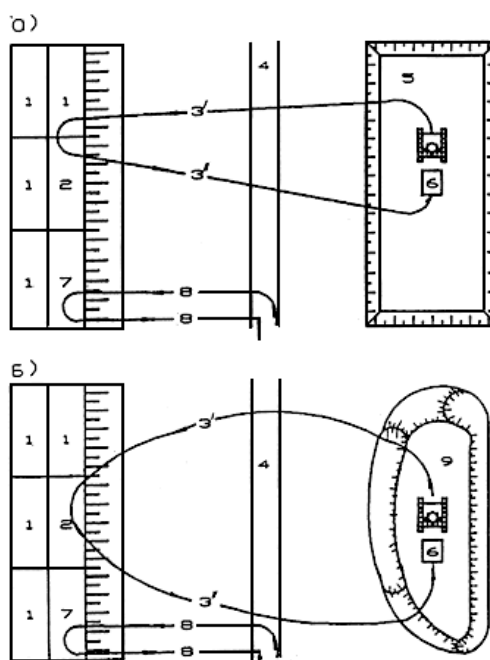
Схема подачи грунта для изоляции ТБО на рабочих картах с помощью скрепера:
